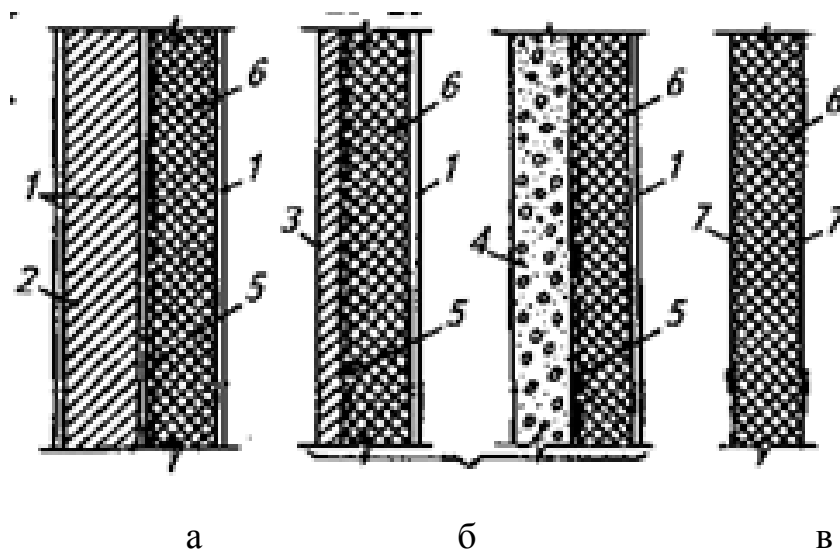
Изоляция наружных стен одноэтажного холодильника:
